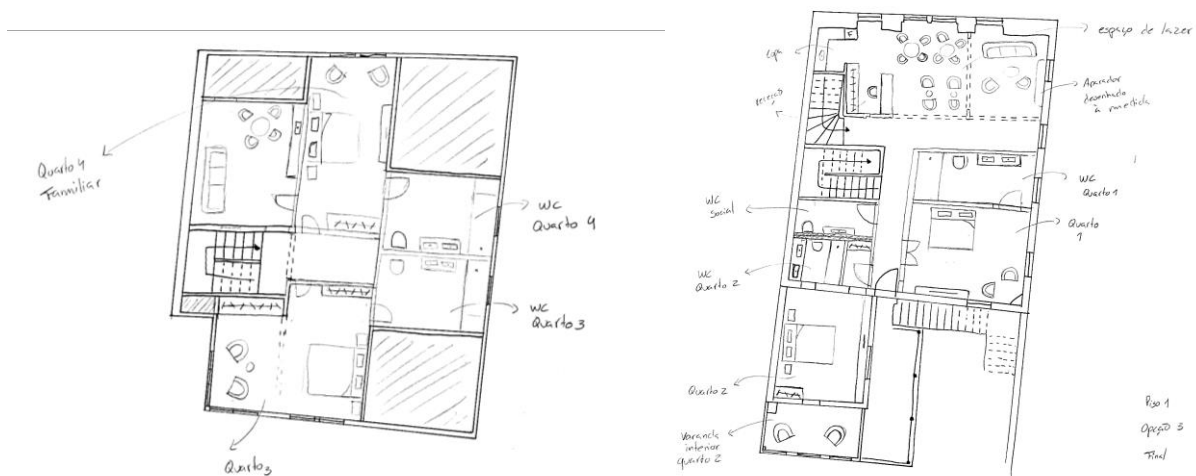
Planta de estudo final. Fonte: Ana Ferreira
